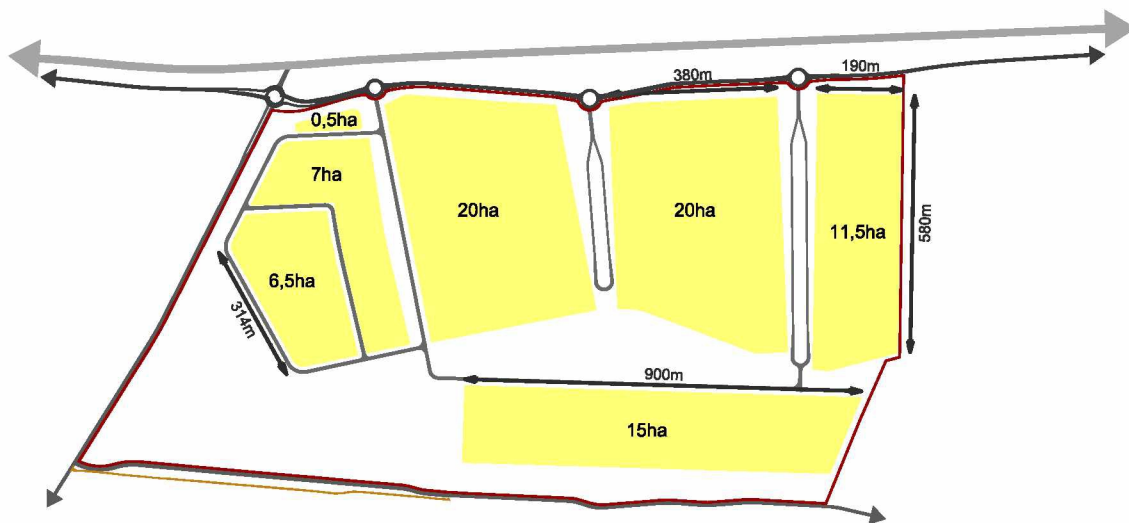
Landschapspark Heesch West en omgeving
